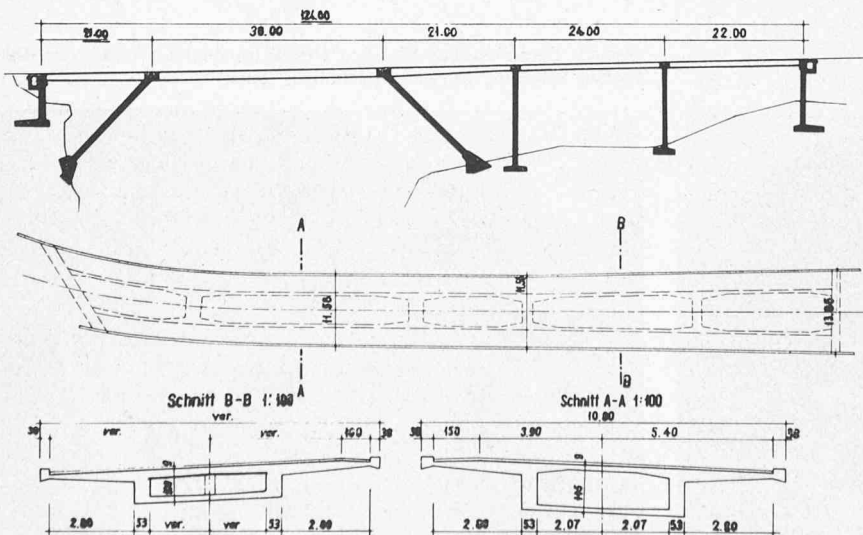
Katasterplan der Soliserbrücke. Oben: Längsschnitt. Unten: Grundriss mit zwei Schnitten
